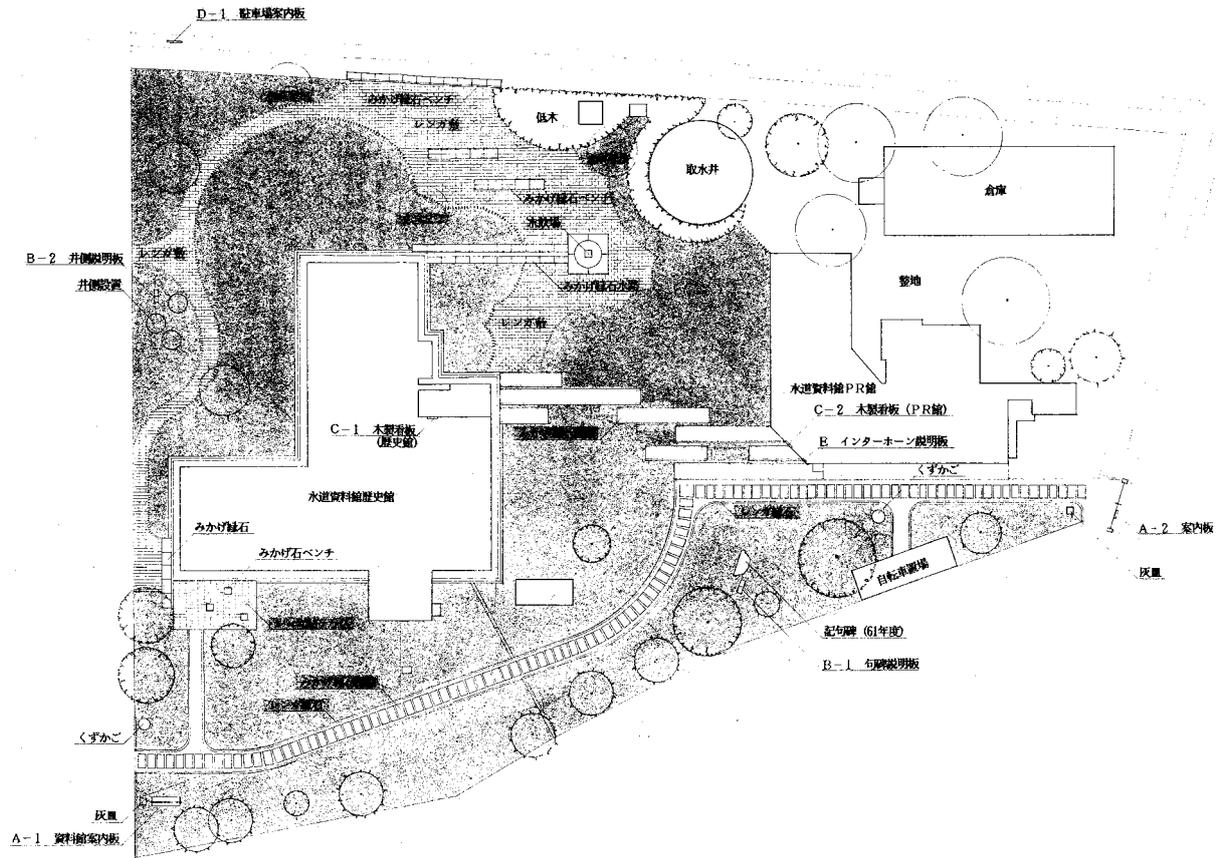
昭和 61 年度外構改修工事 全体計画平面図
